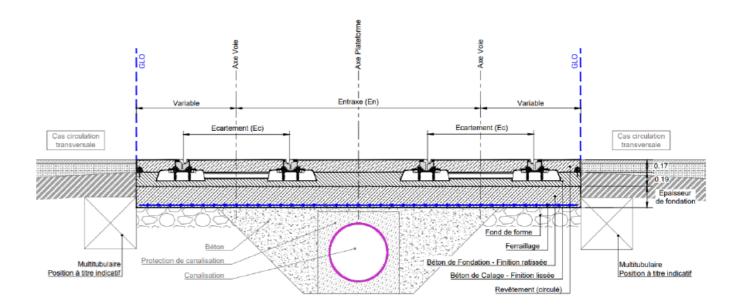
coupe transversale de plateforme sur zone de pontage d'un réseau longitudinal.
